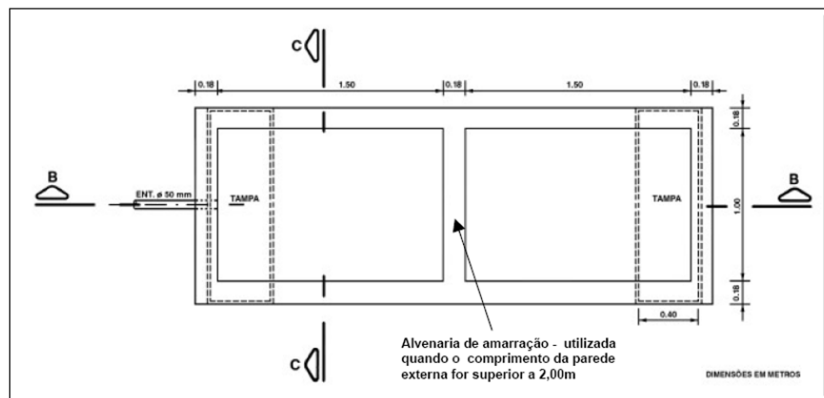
Planta baixa do detalhamento construtivo do sumidouro
